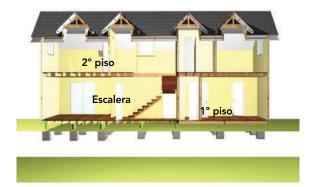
1b: Corte longitudinal de la vivienda tipo en que se observa el perfil de la escalera, establecido en el diseño arquitectónico y estructural de la vivienda.
